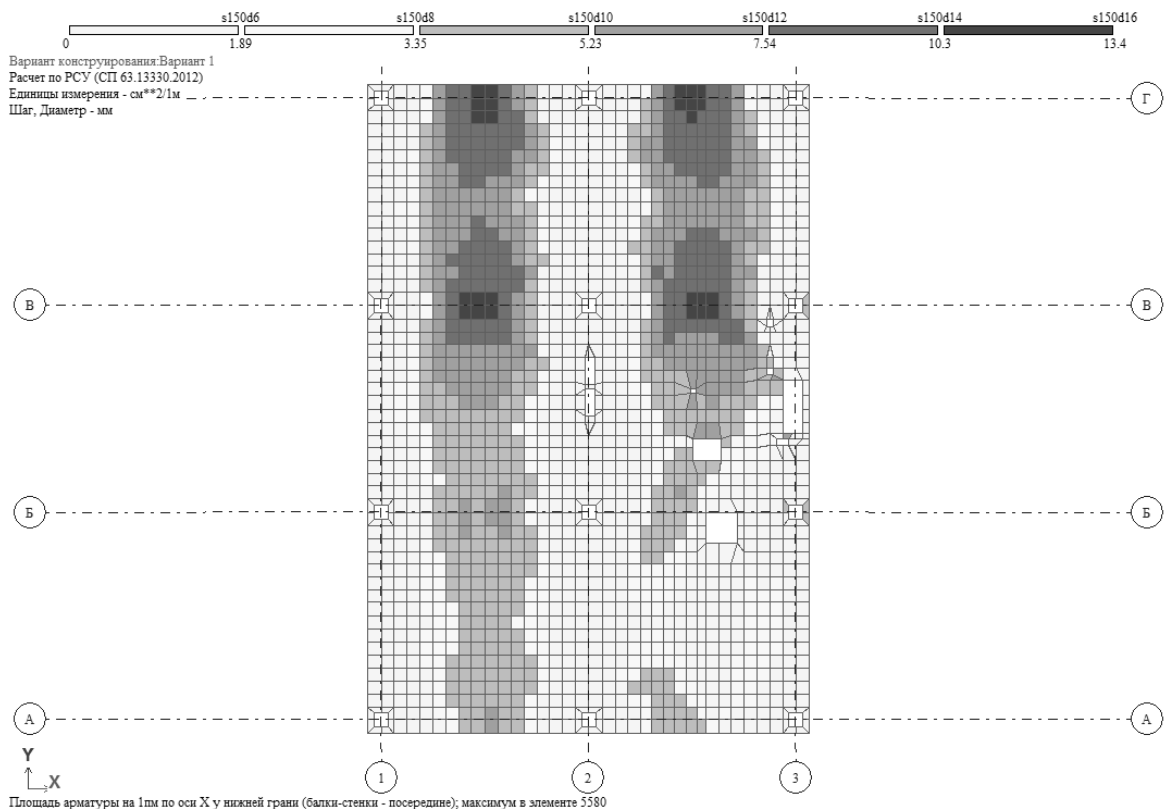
Армирование плит покрытия по оси X у нижней грани
